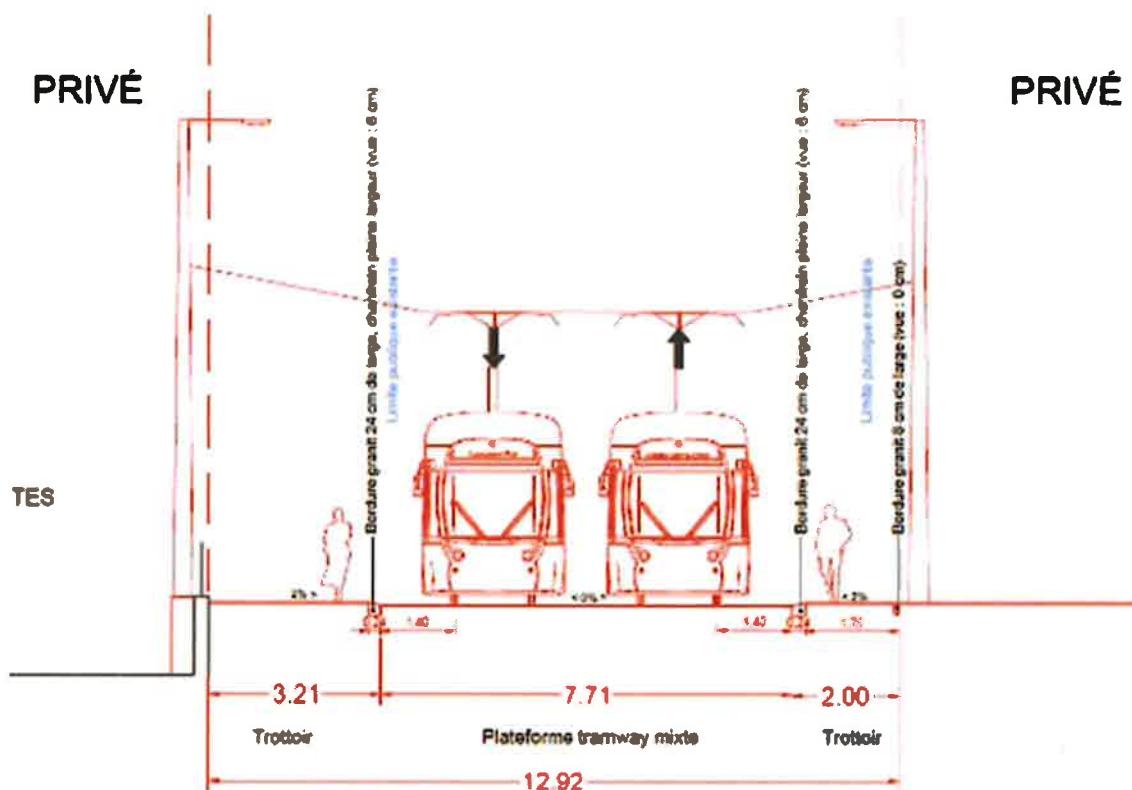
Coupe de principe dans le secteur Pont-Bleu
